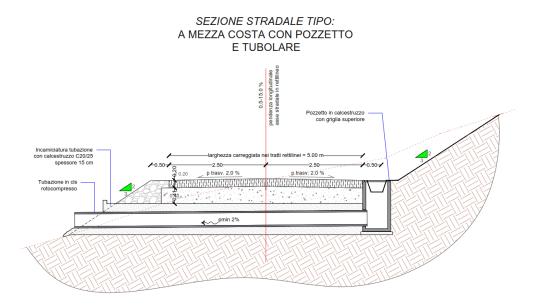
Sezione stradale tipo a mezza costa con pozzetto e tubolare
